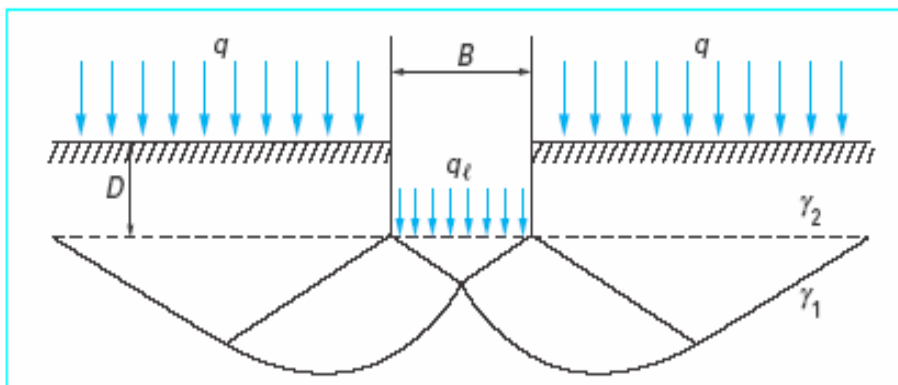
Schéma de rapture d'une fondation superficielle.
